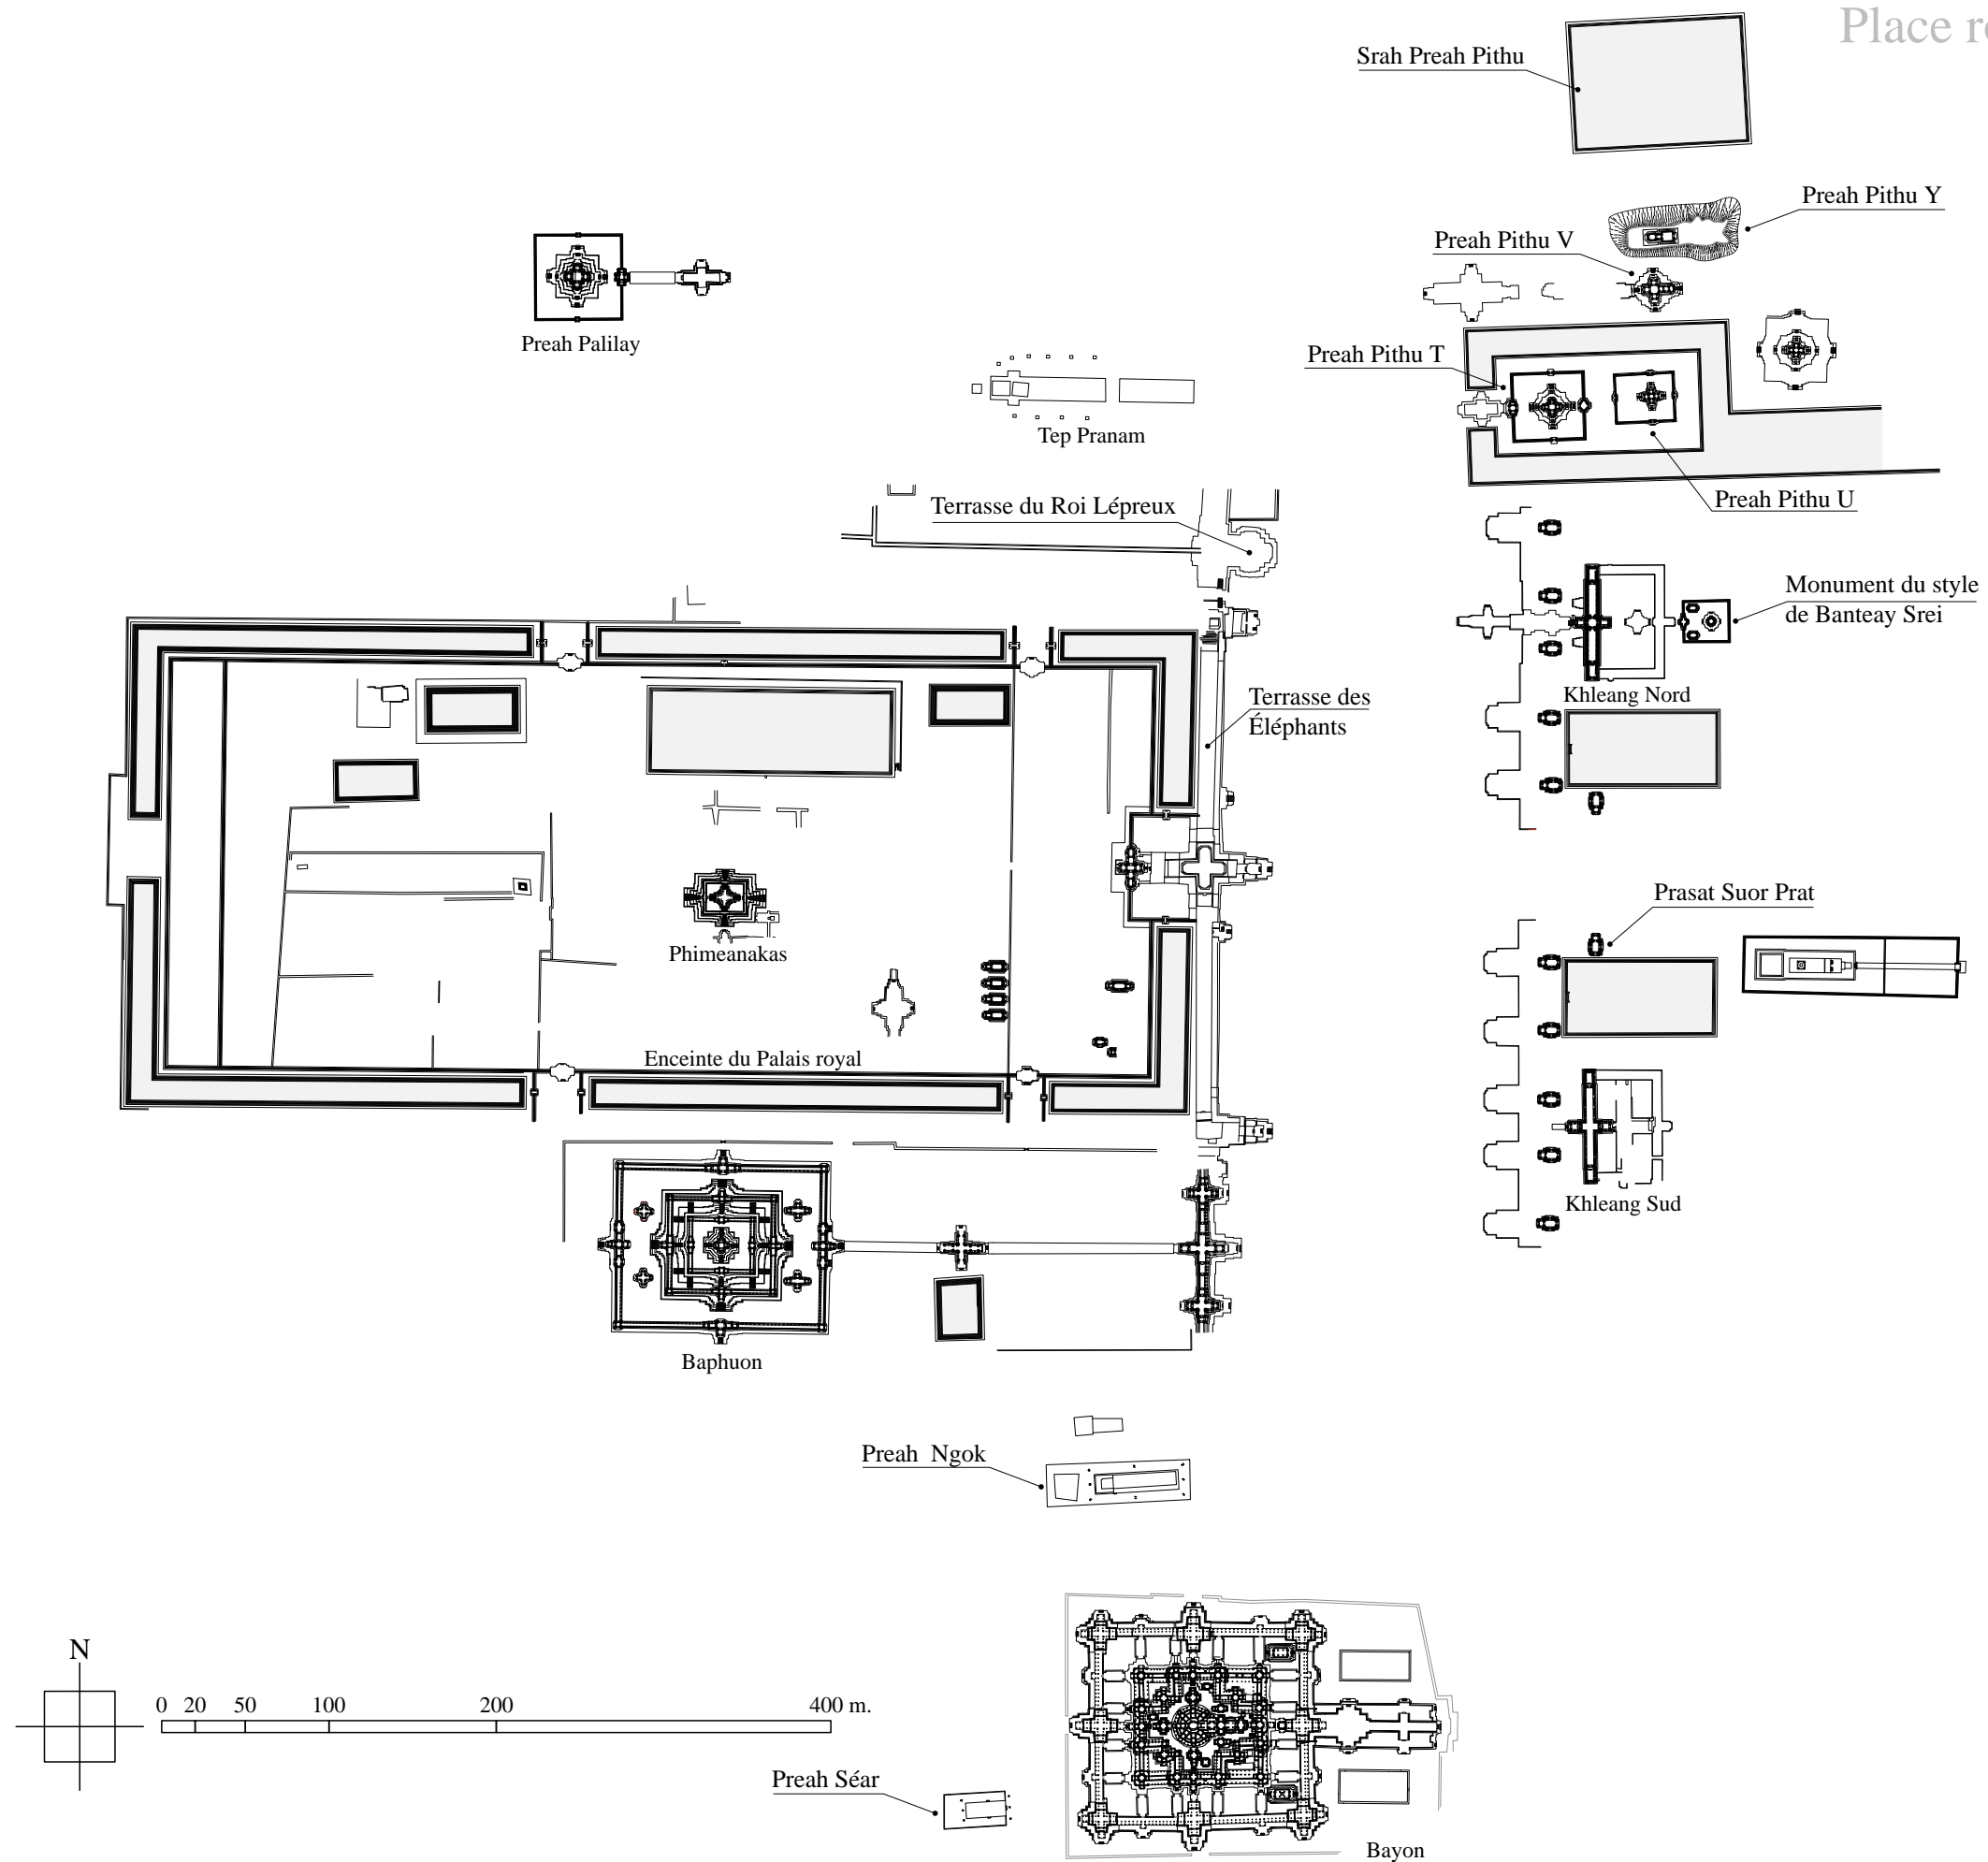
Plan de la place royale d'Angkor Thom
